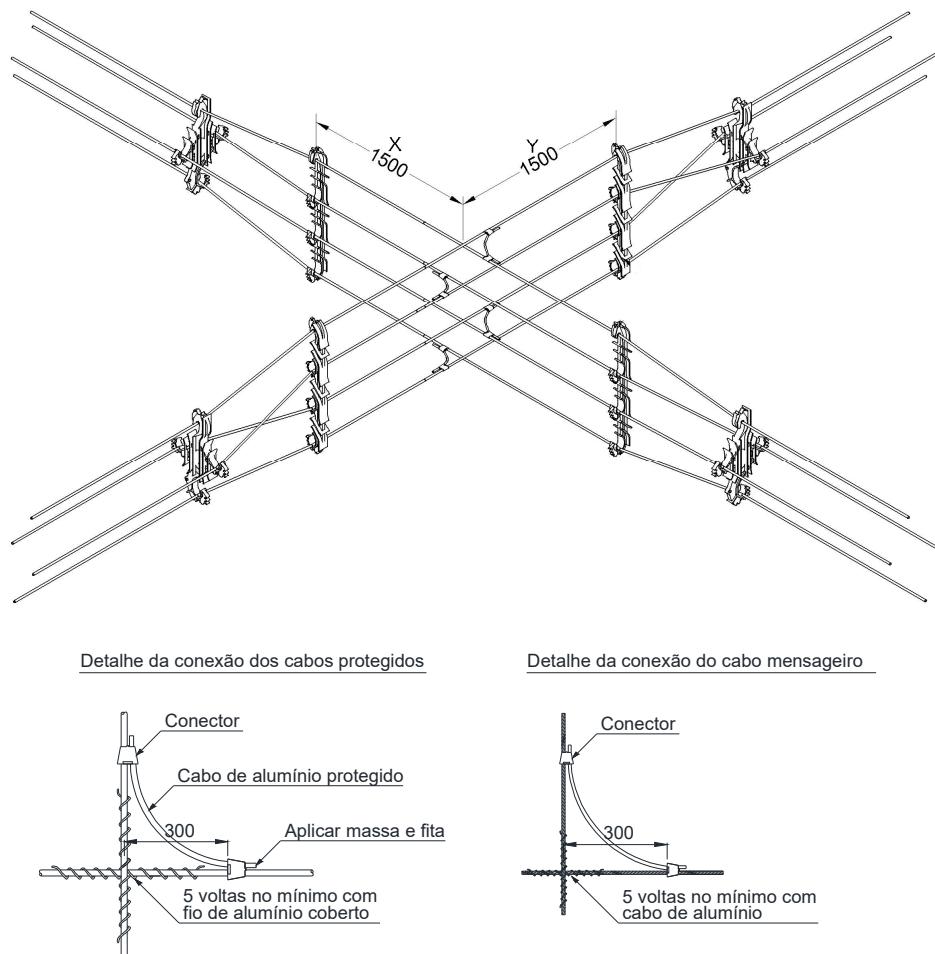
Amarrações e ligações – Cruzamento aéreo
